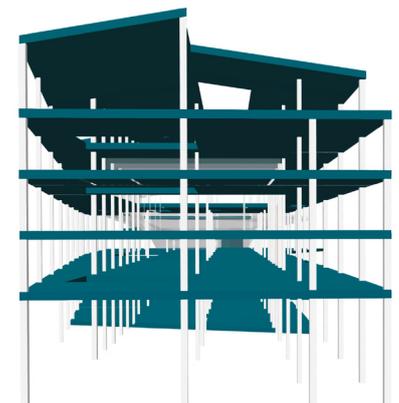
Darstellung Tragwerk Geschossdecken
